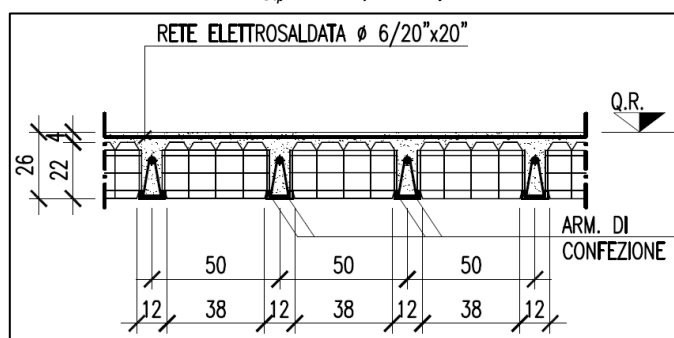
Sezione corrente della soletta laterocementizia del 2° piano
